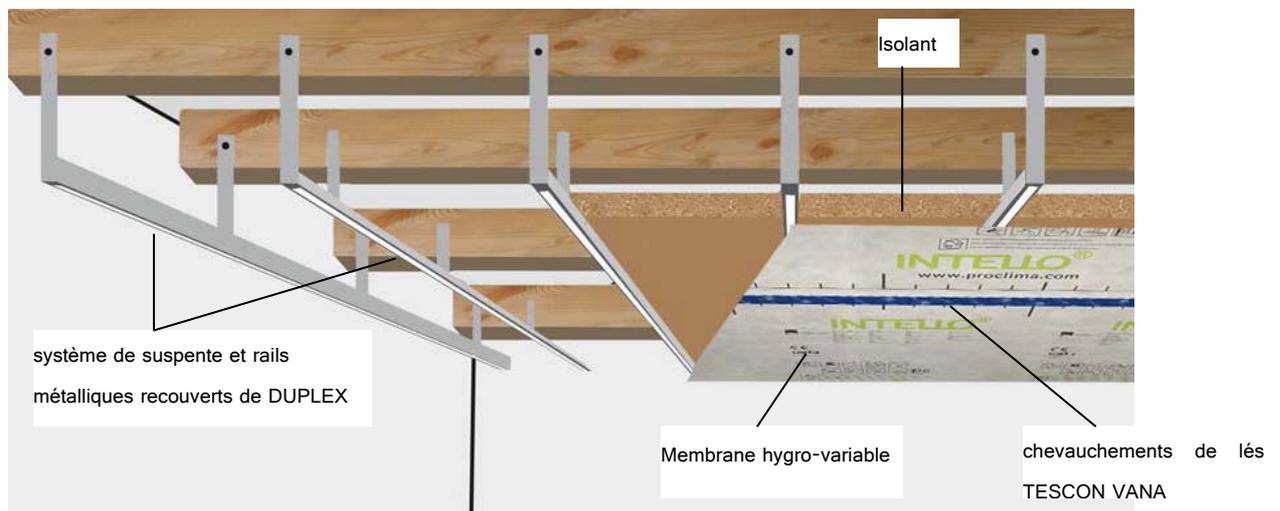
Collage de la membrane INTELLO dans le cas d'un faux-plafond
